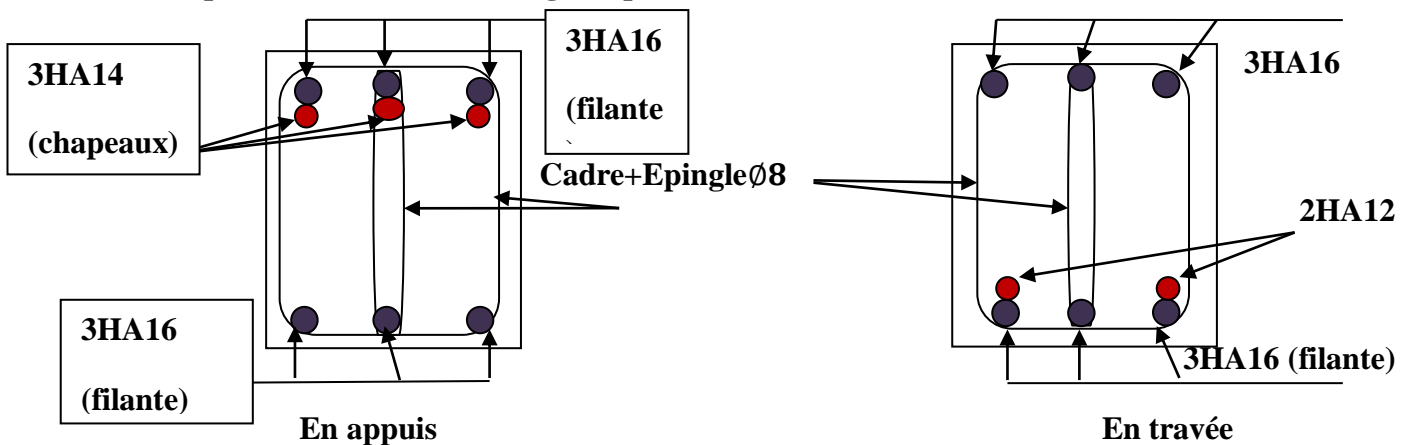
Schéma de ferrailage des poutres Y-Y (30.40) entre sol (1,2,3)ᶠ.
